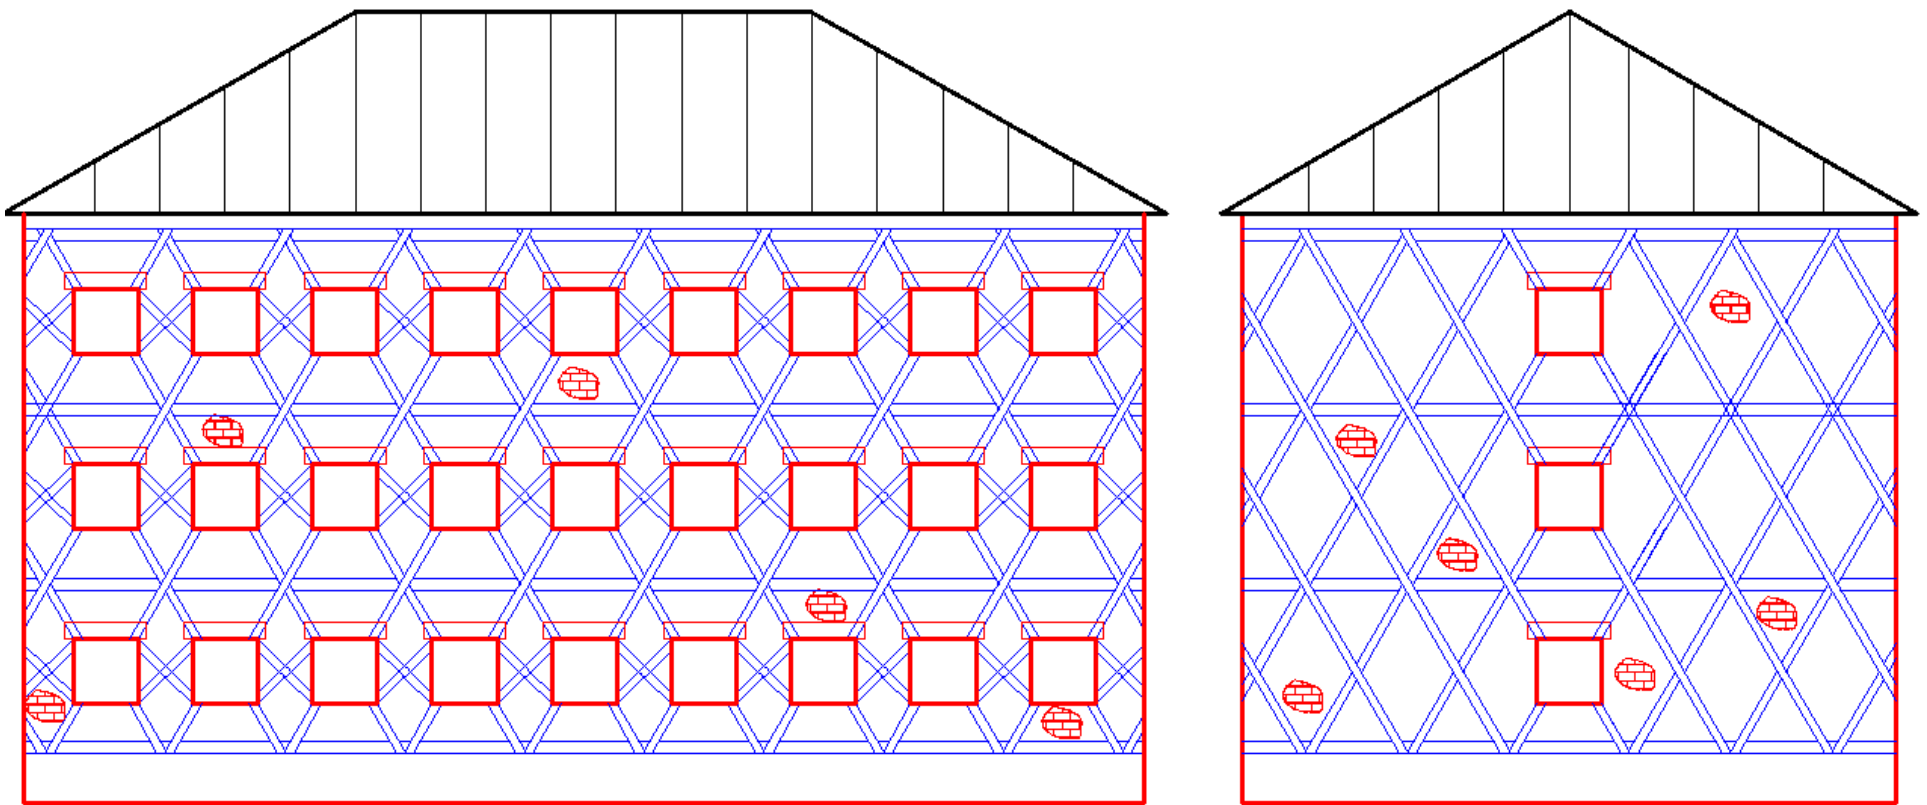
Схема усиления каменных стен зданий, поврежденных при землетрясениях или неравномерных осадках основания
